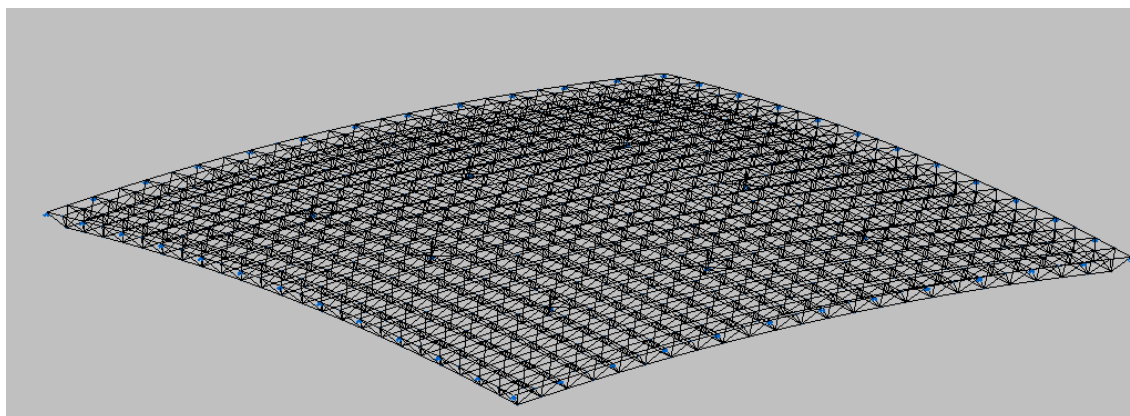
Vista 3D de estructura espacial de cubierta.
